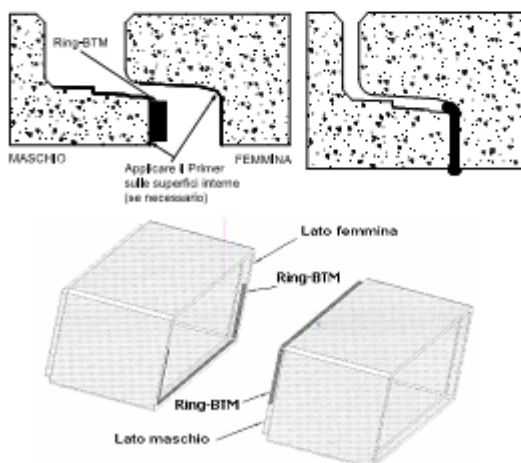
M : Specifica tecnica pozzo autoaffondante rettangolare
